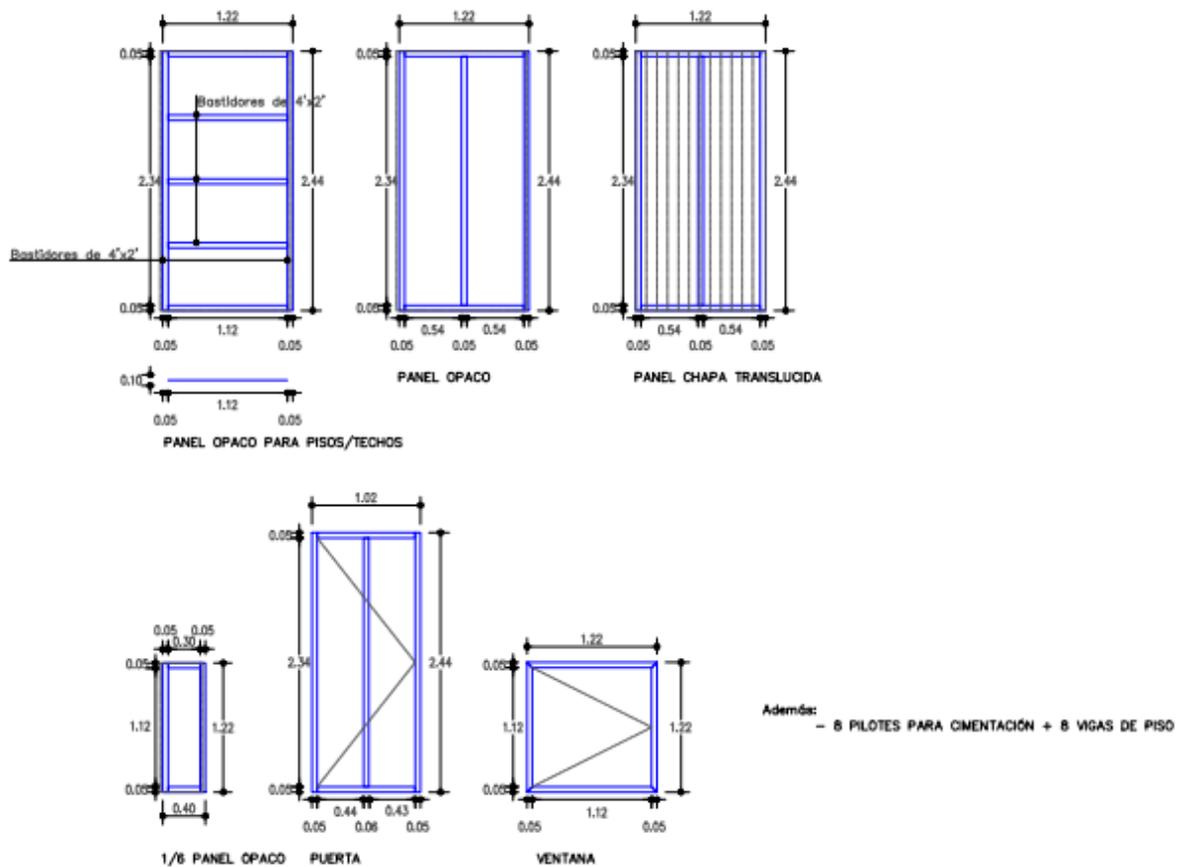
Diseño de los paneles para alternativa de vivienda prefabricada. Fuente: TECHO.
